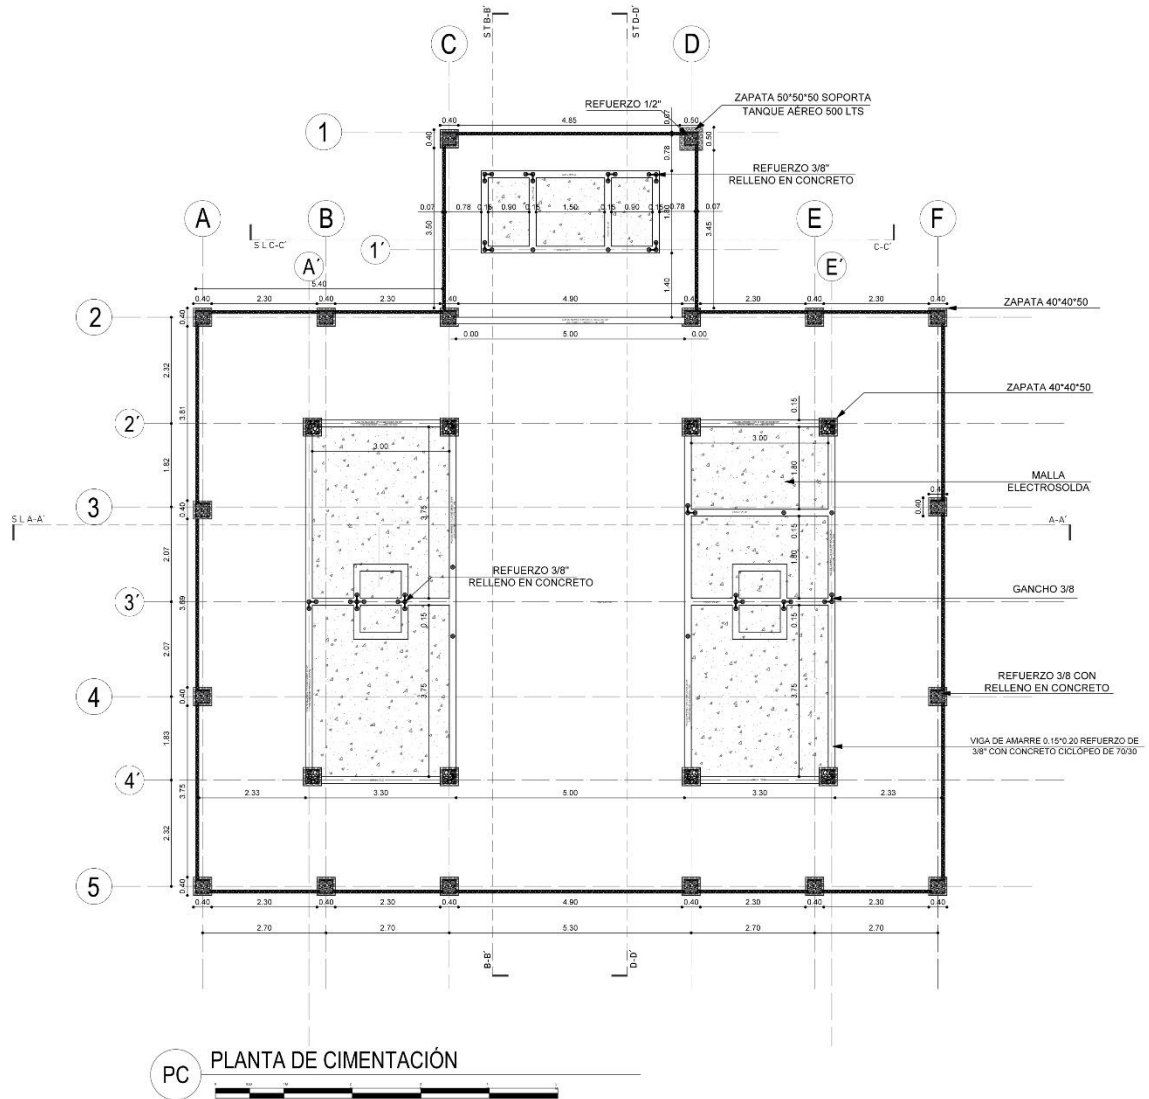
Plano arquitectónico propuesta de vivienda indígena
